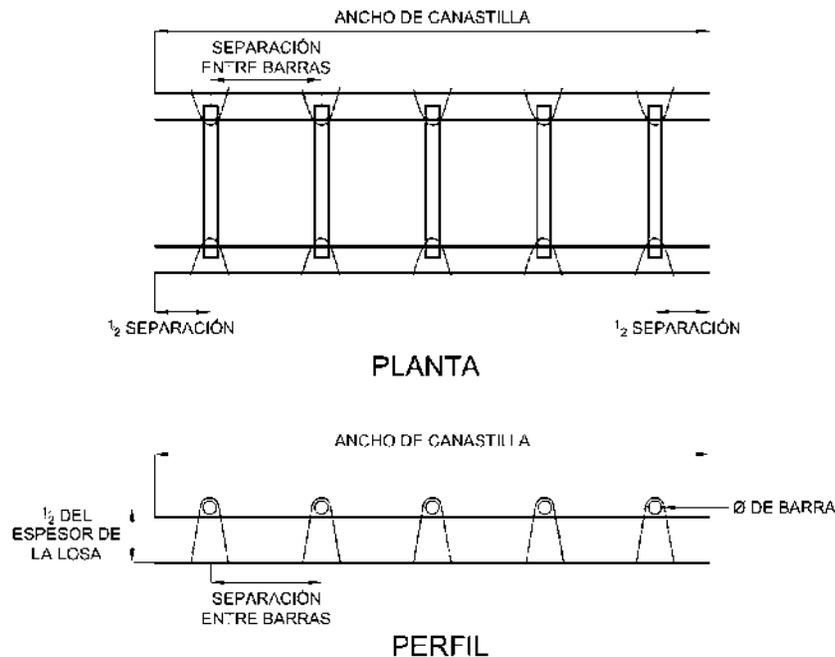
Armazones de barras de pasajuntas (Canastillas). (Elaboración propia)
